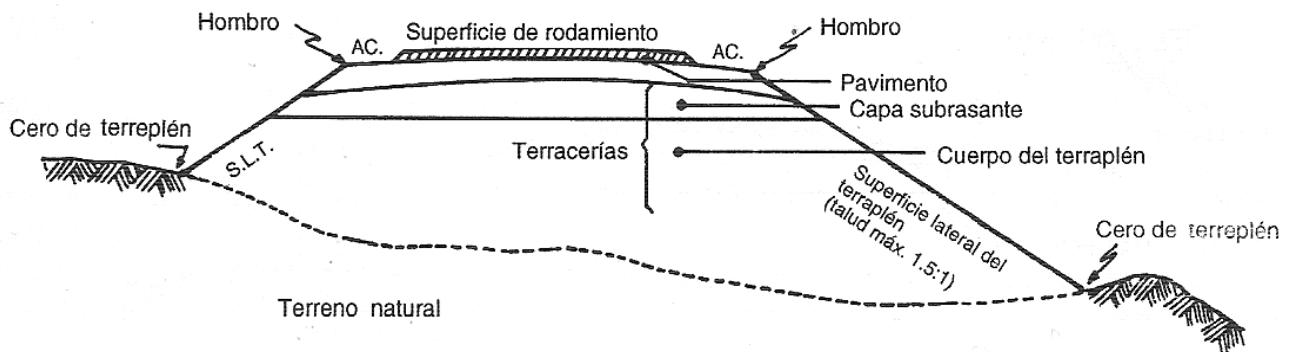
Sección transversal típica en terraplén para carreteras de dos carriles.
